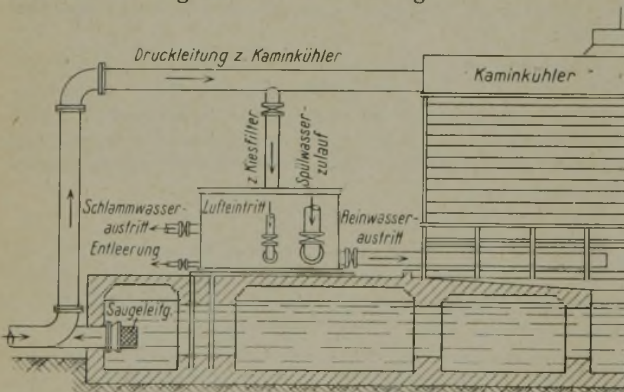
Filter zum Entfernen der groben Niederschläge aus dem Kühlwasserkreislauf.
